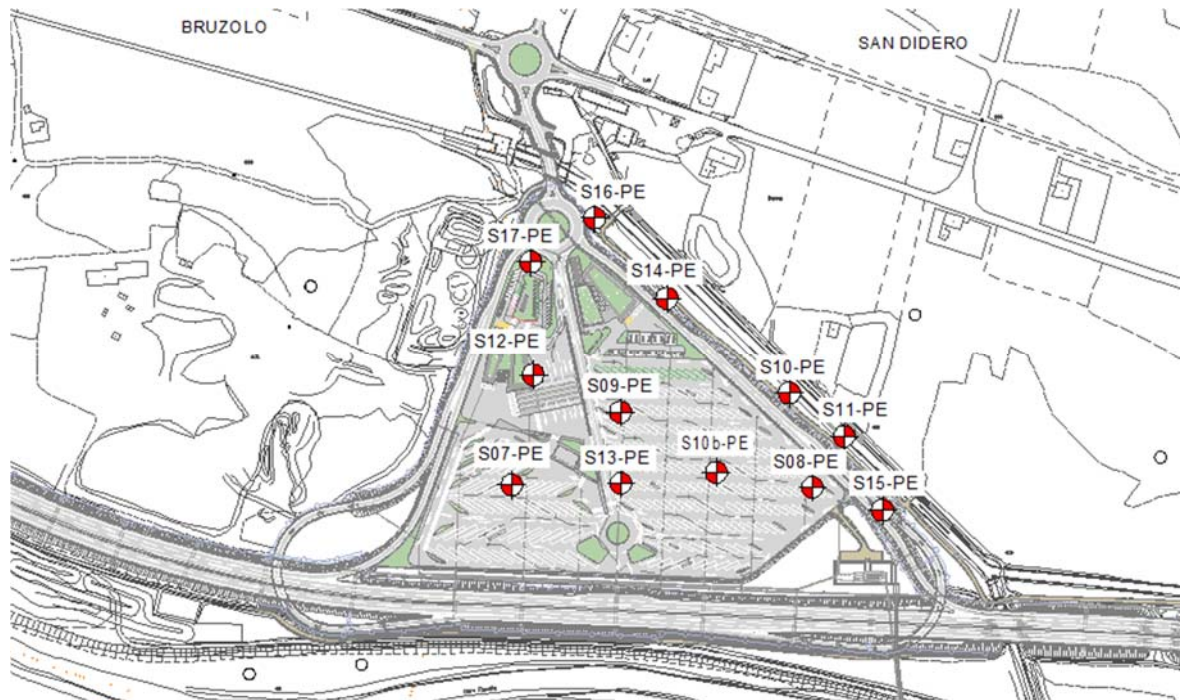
Planimetria di localizzazione delle indagini di progetto esecutivo con sovrapposizione progetto
